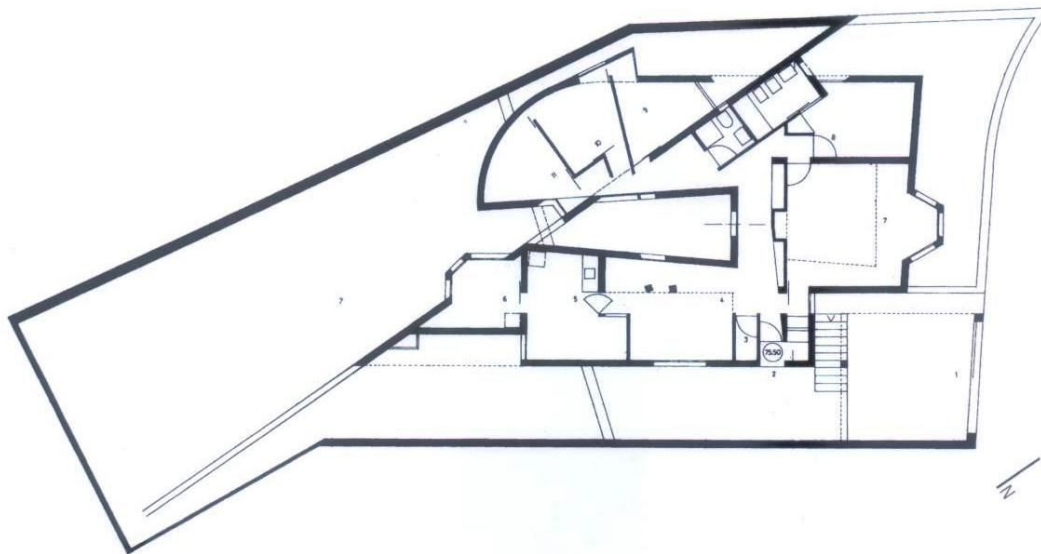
Álvaro Siza. Planta da casa Carlos Siza. Santo Tirso. Sem escala.
